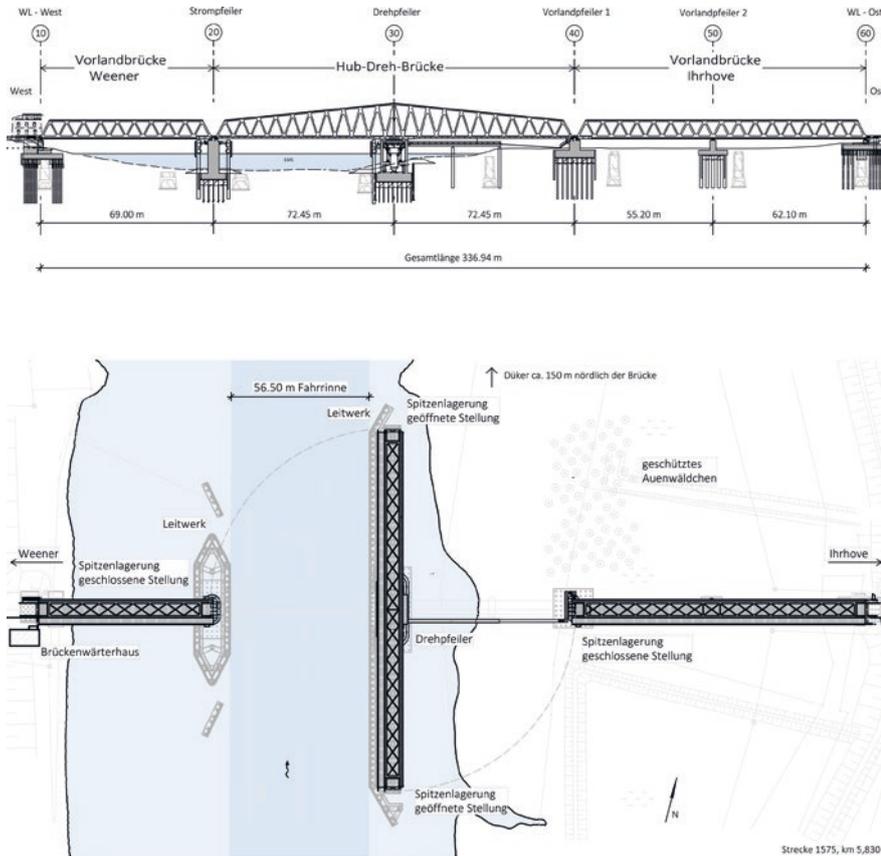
Längsansicht und Draufsicht der Friesenbrücke [10]
